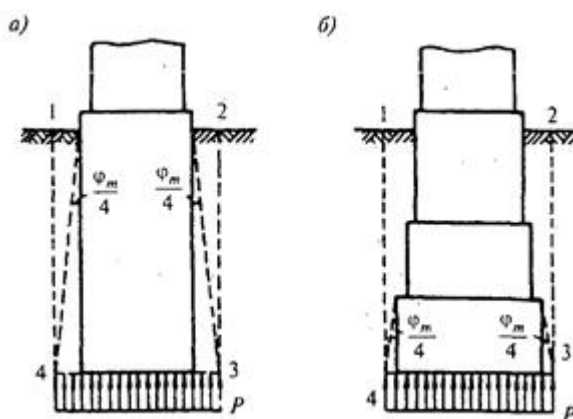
Условный свайный фундамент с ростверком, заглубленным в грунт, при угле наклона свай более  $\varphi_m/4$
